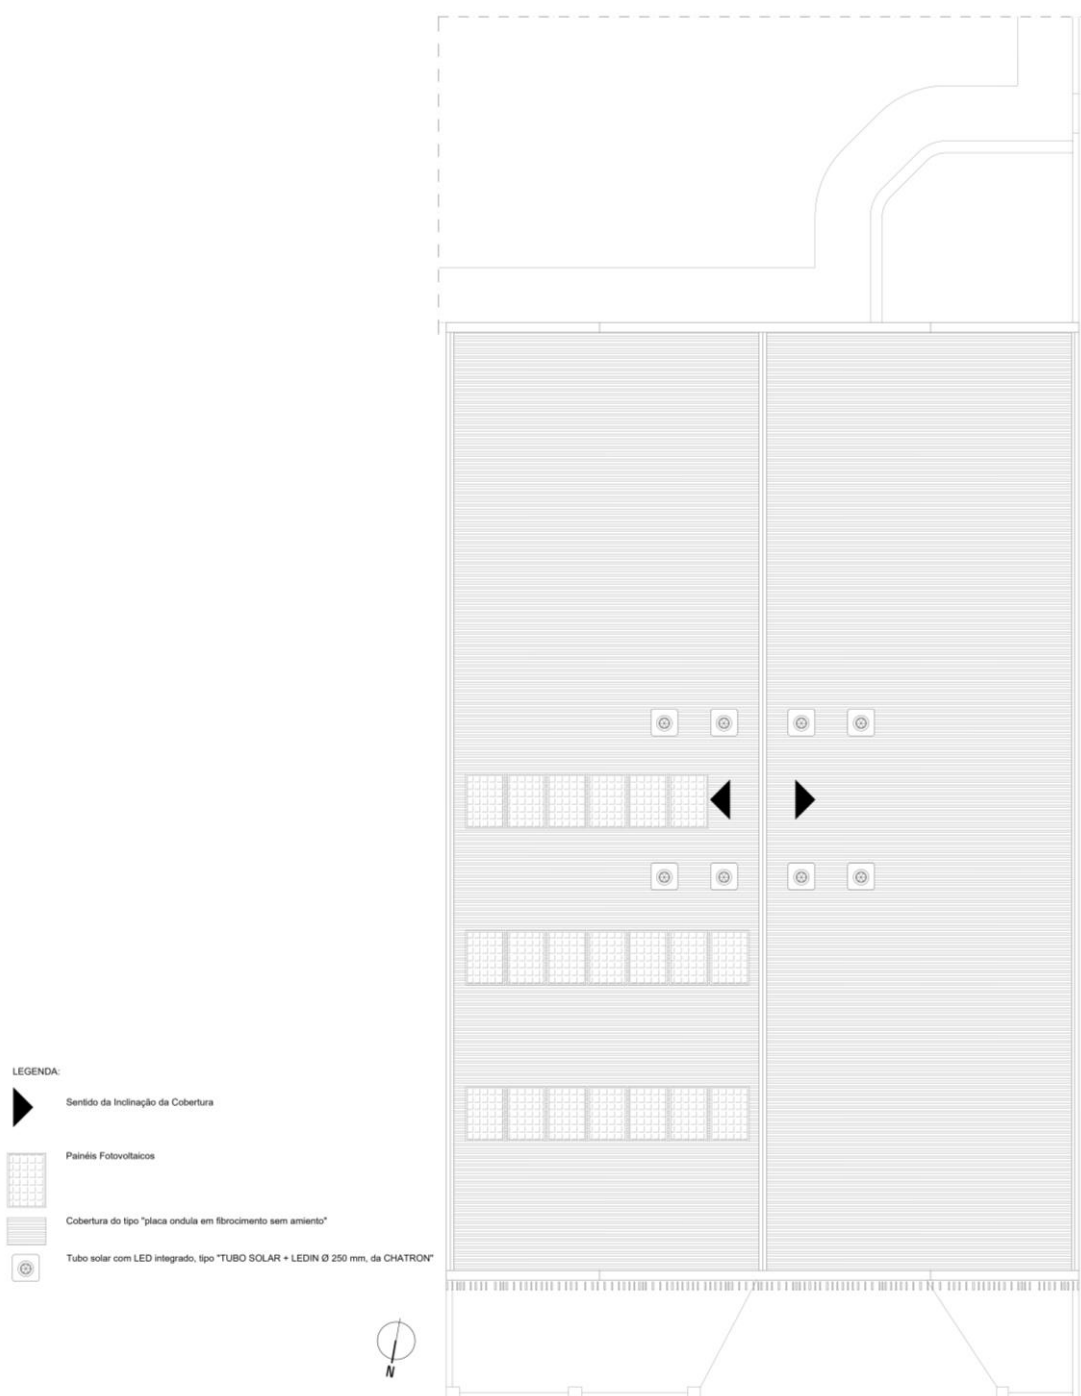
Desenho Técnico - Planta de Cobertura. Fonte: (Autor)
